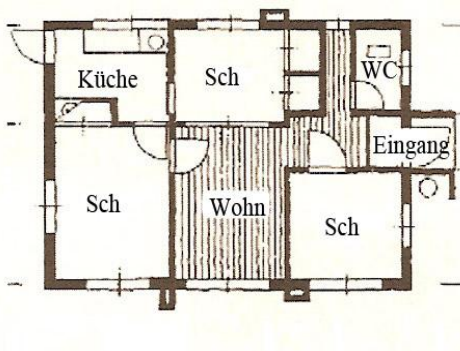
Grundriss einer späteren Young-Dan-Wohnung
